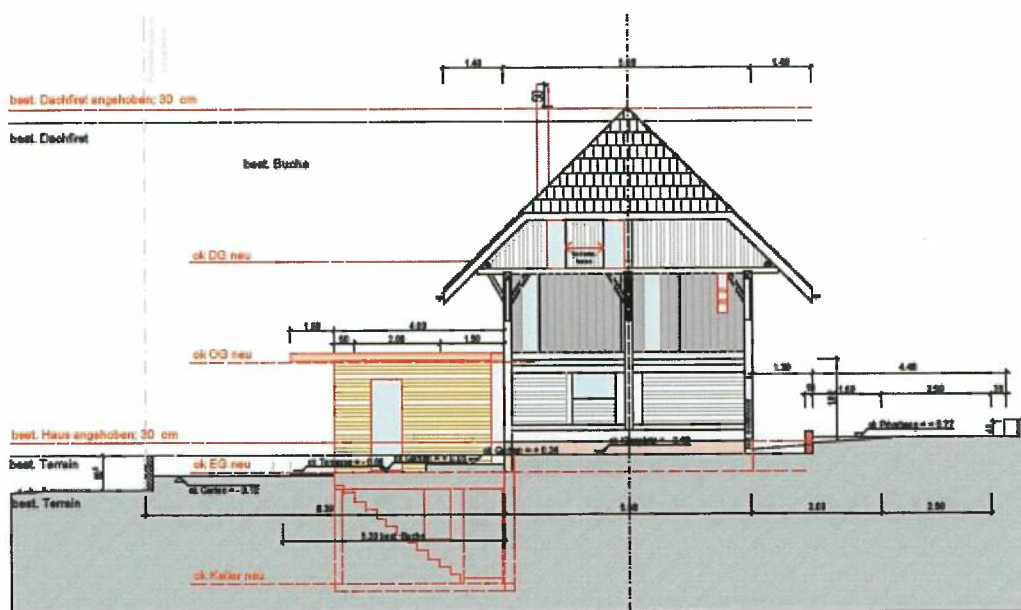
Werkplan Südostfassade Mst. 1:100 (C. Wiedmer)
